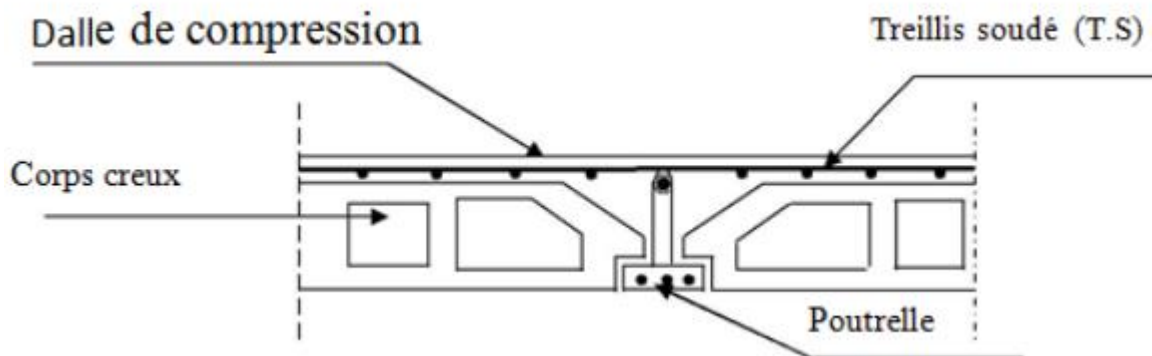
Coupe transversale d'un plancher en corps creux.
